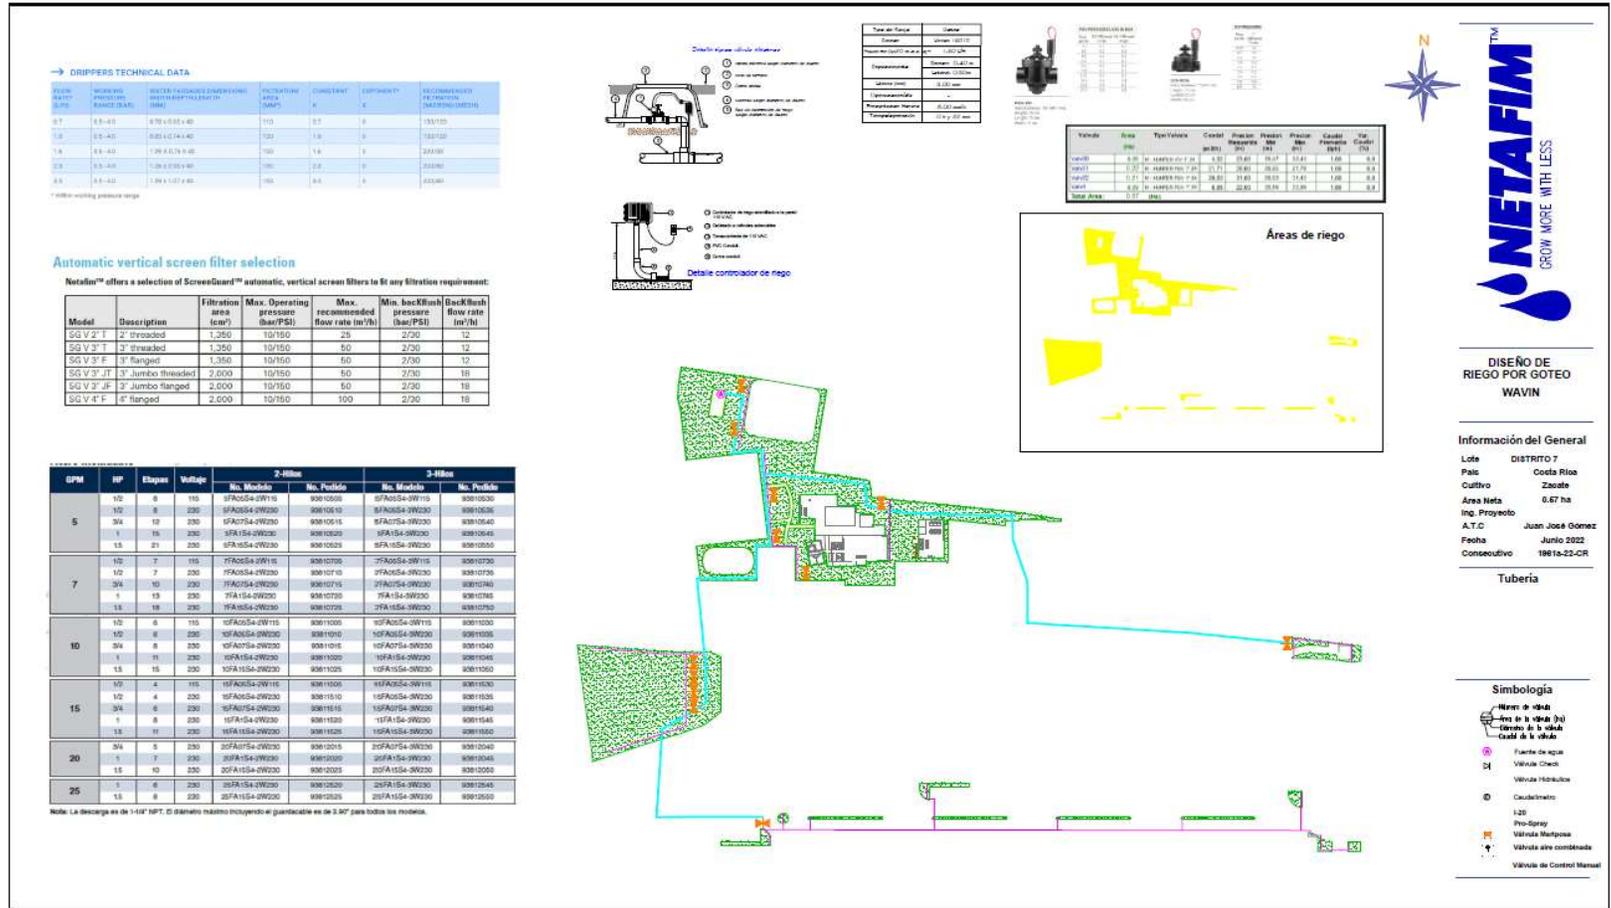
Sistema de Riego para Reúso de Planta de Tratamiento. Lamina Constructiva sin número.
